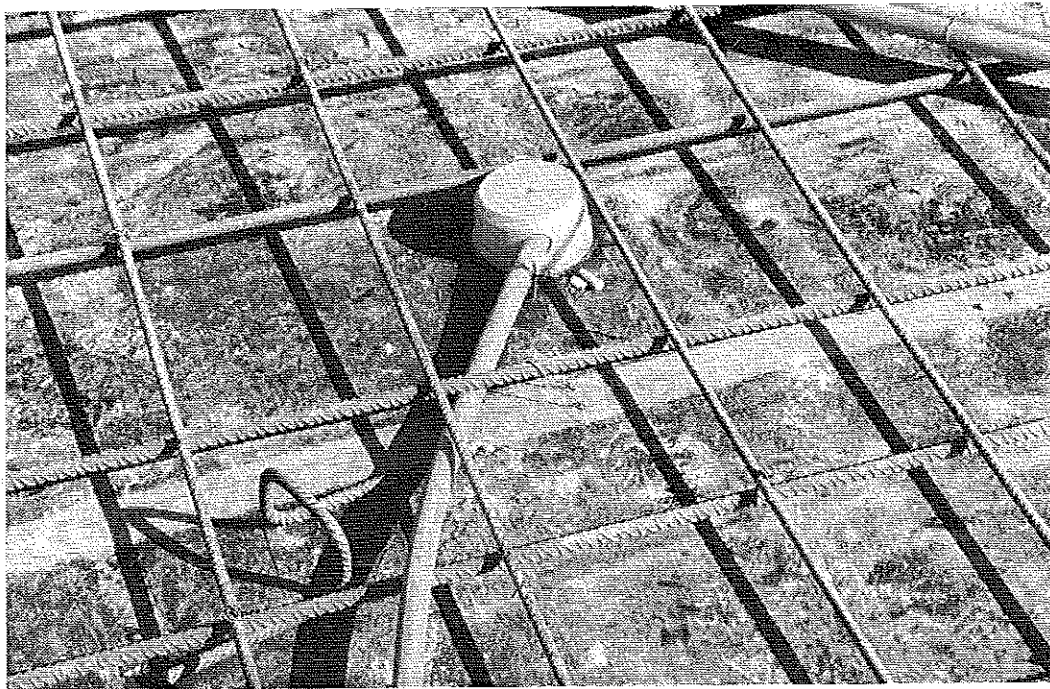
Boîte de raccordement installée sur coffrage. Les armatures sont déplacées vers le haut.
